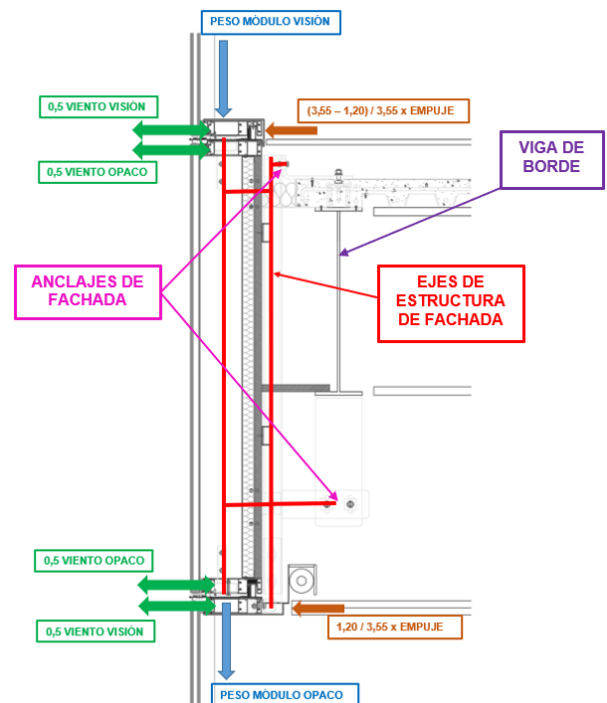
Esquema de anclaje previsto por el fabricante de la fachada
